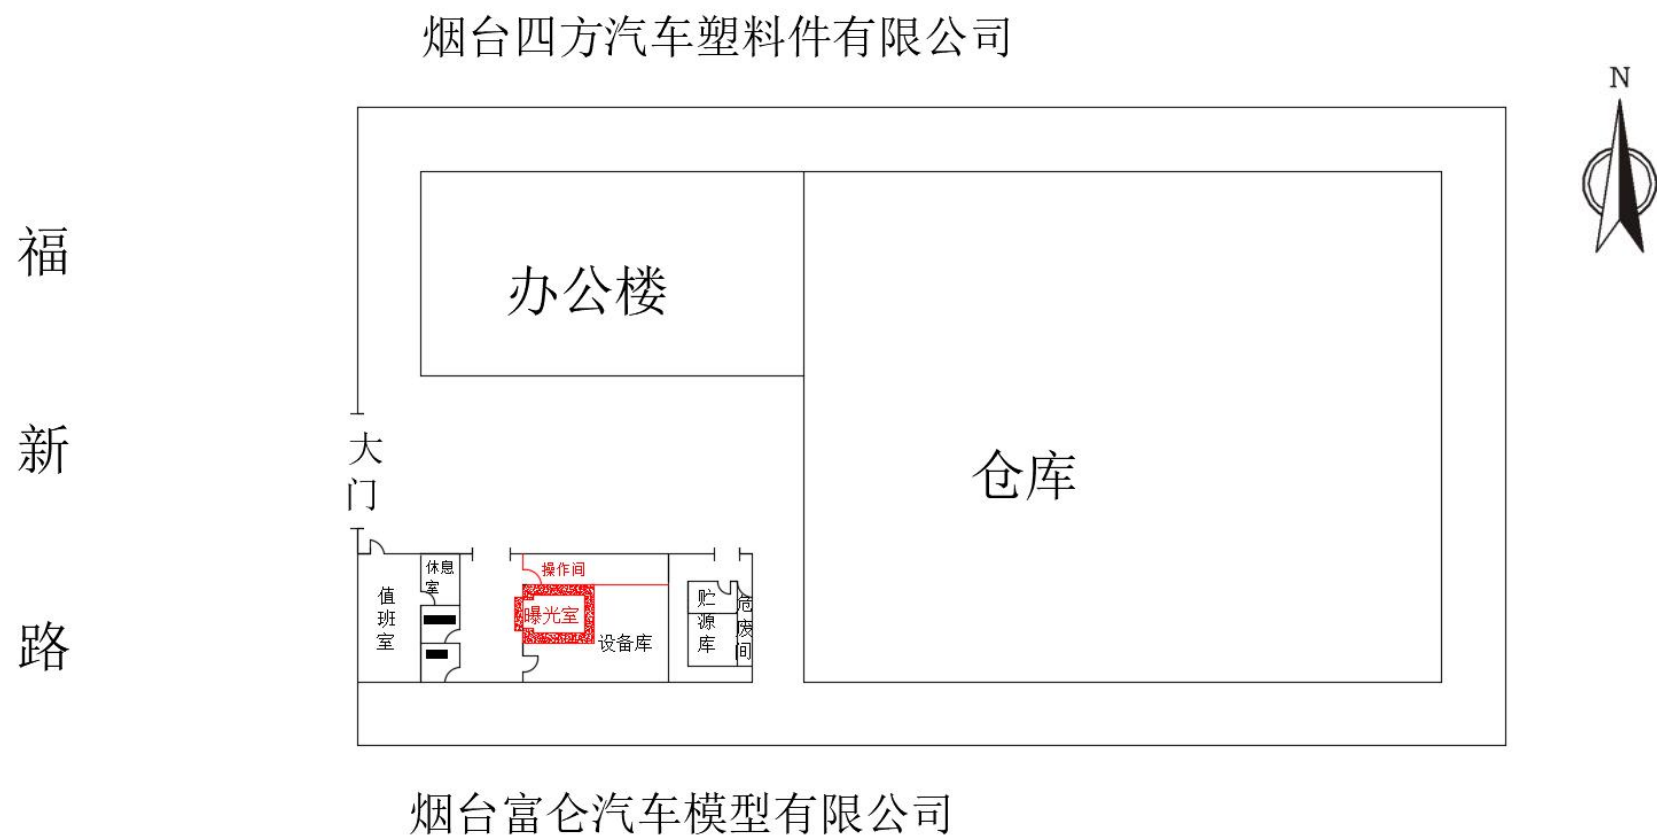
烟台开达无损检测技术服务有限公司平面布置示意图
